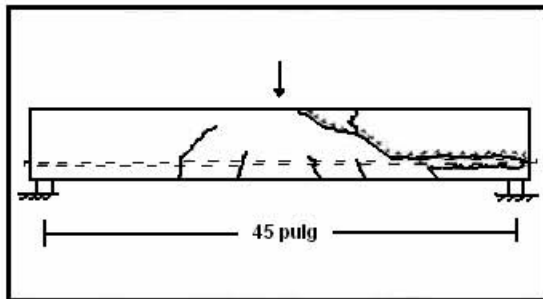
Formación de grietas por cortante en una viga de concreto (Plechnik et al., 1986)
